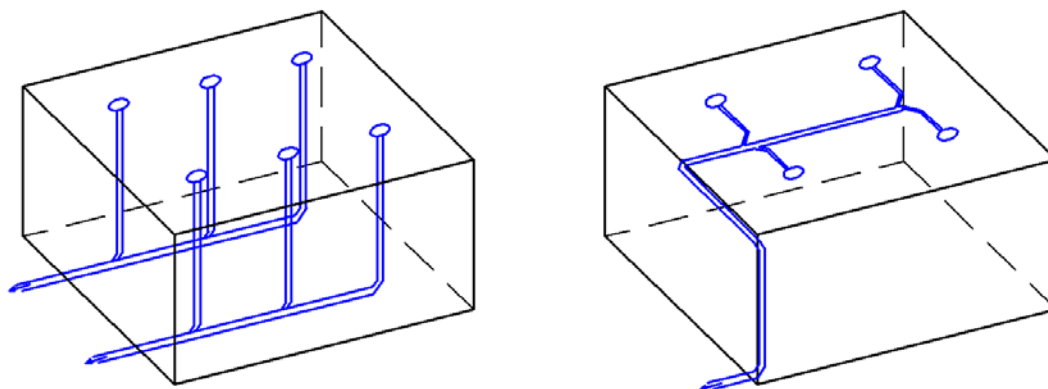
Confronto tra drenaggio a gravità tradizionale e drenaggio a pressione.
